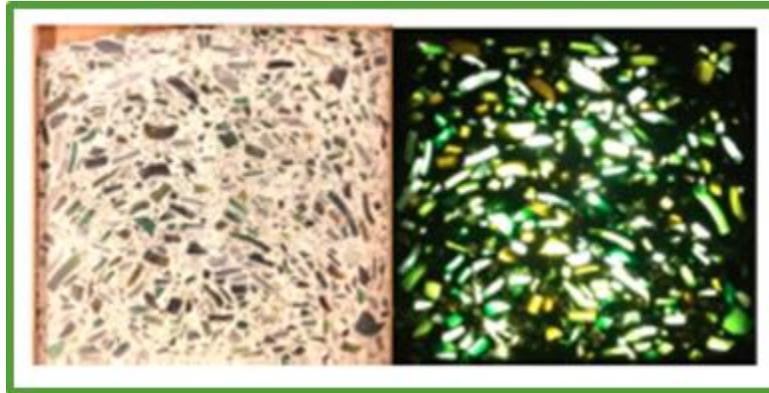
Placa de concreto translúcido. Modificado de Spiesz , et al. (2016)
